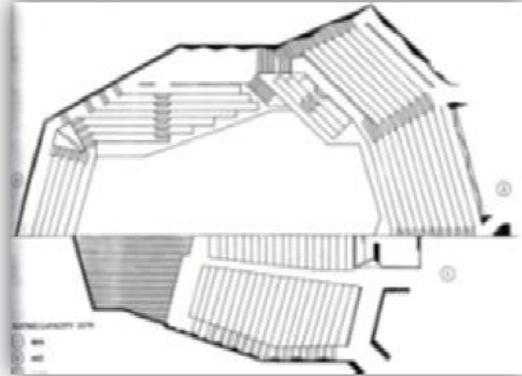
Plantas arquitectónicas. Sin escala. Fuente: Concert halls and opera houses. Beranek, L.
